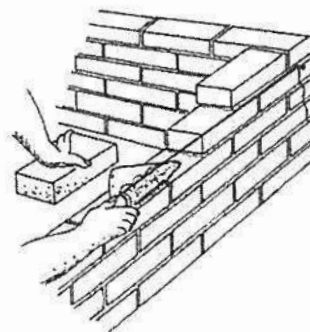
Detalhe do nivelamento da elevação da parede.
